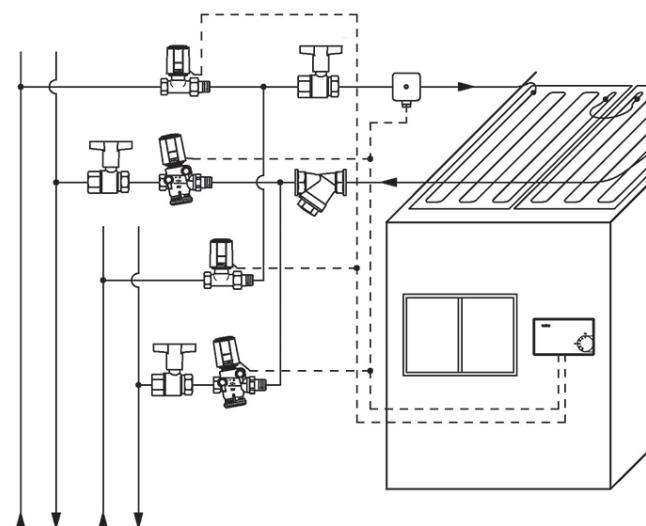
Exemple d'installation 2 : Système à quatre conduites
